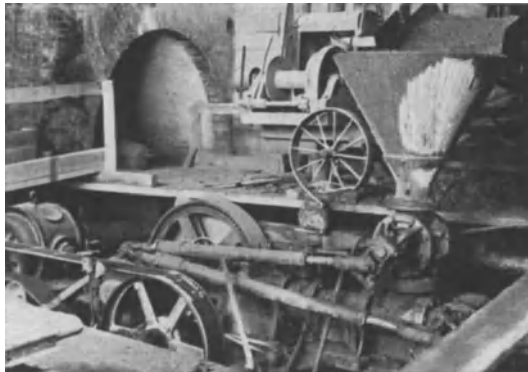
Betonpumpe zur Beförderung angemachten Frischbetons.
